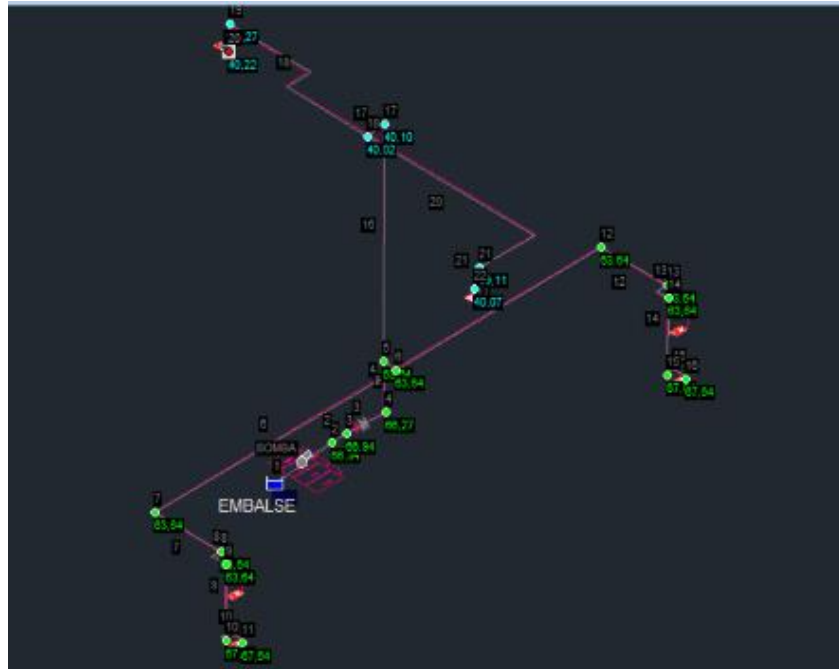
Diseño de Red BIEs sobre Isométrica. EPANET
